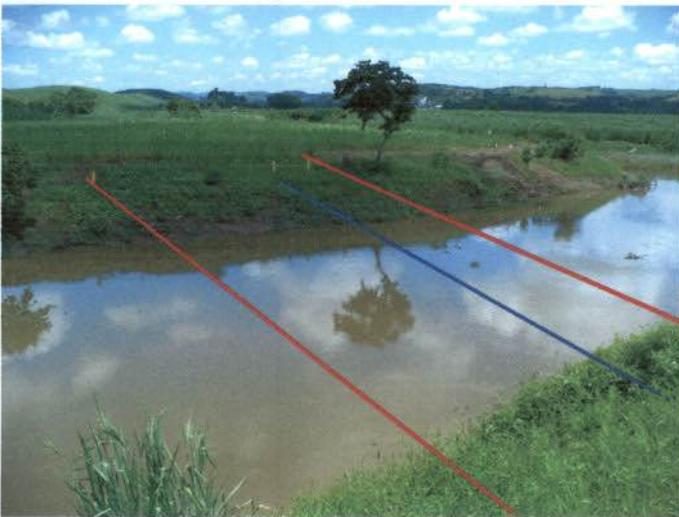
nova vista da travessia do Rio Ipojuca, com indicação da posição do duto existente dentro da faixa.
